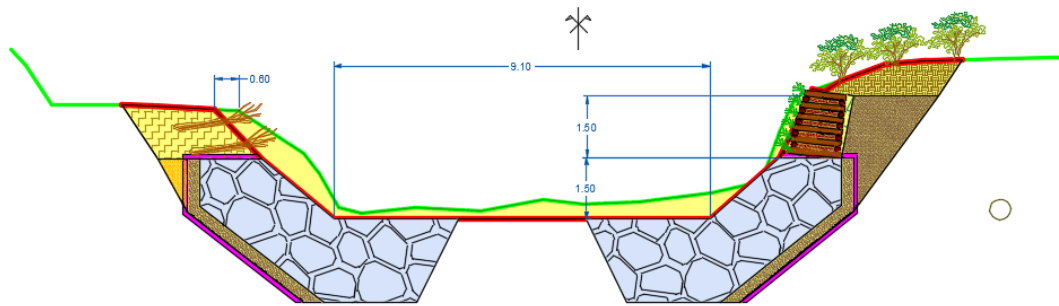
Coupe type des protections de berge en rive droite et gauche en aval de la rampe
